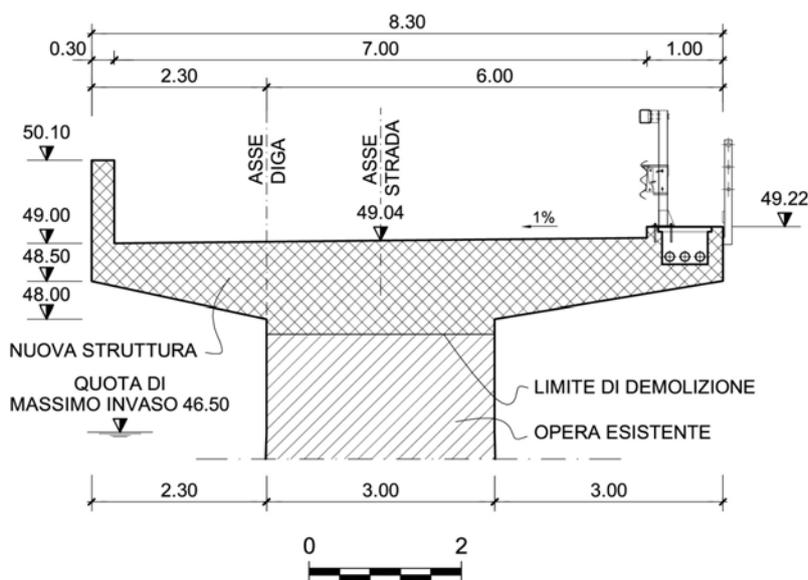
Dettaglio del sovralzato di un concio emergente - Situazione finale.
